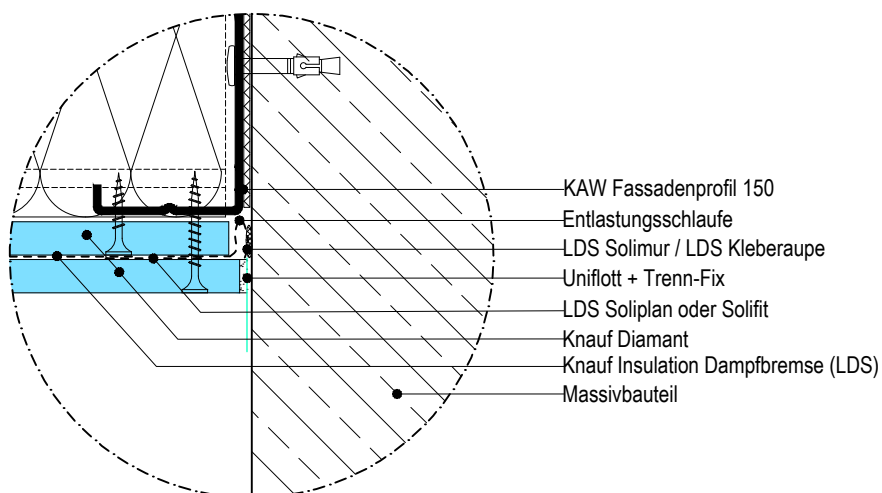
Detail A Vertikaler Folienvverlauf LDS an Bodenplatte
